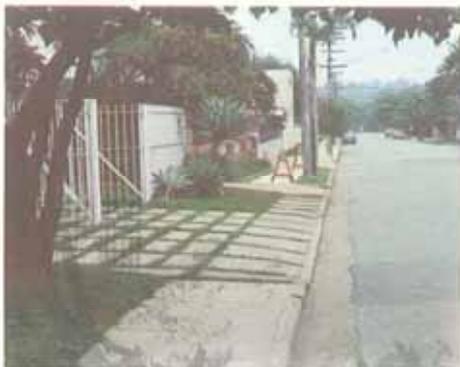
e 7 — CALÇADAS COM LAJOTAS DE CONCRETO
